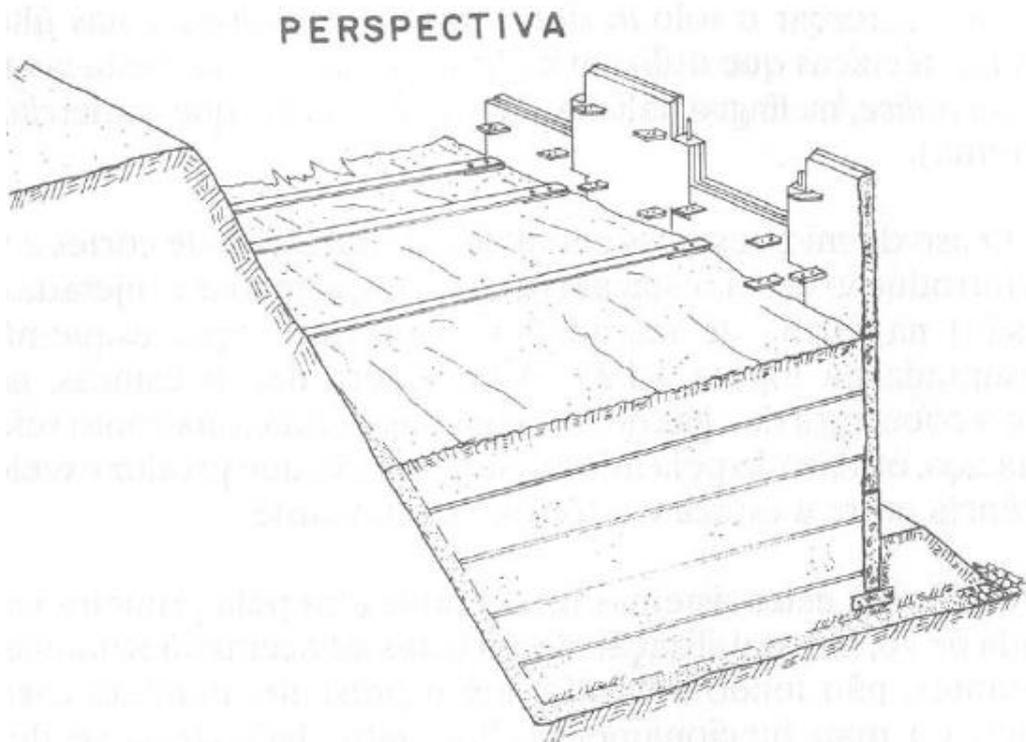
Detalhe Construtivo - "Terra Armada"
